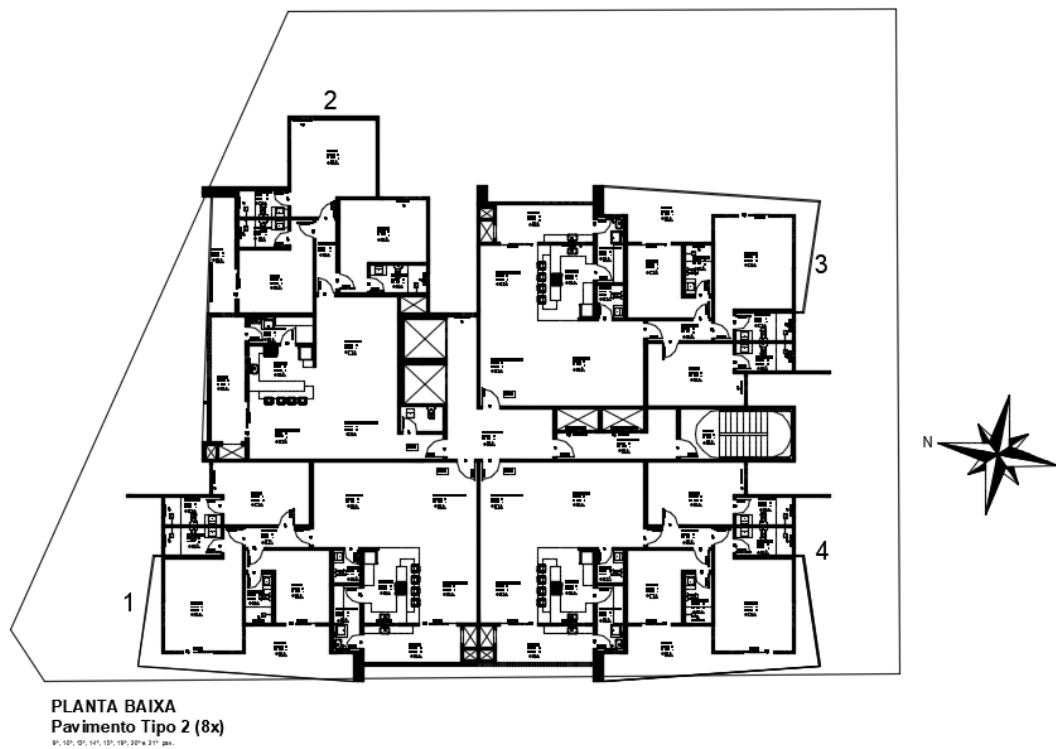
Projeto Arquitetônico – APARTAMENTO TIPO 2
